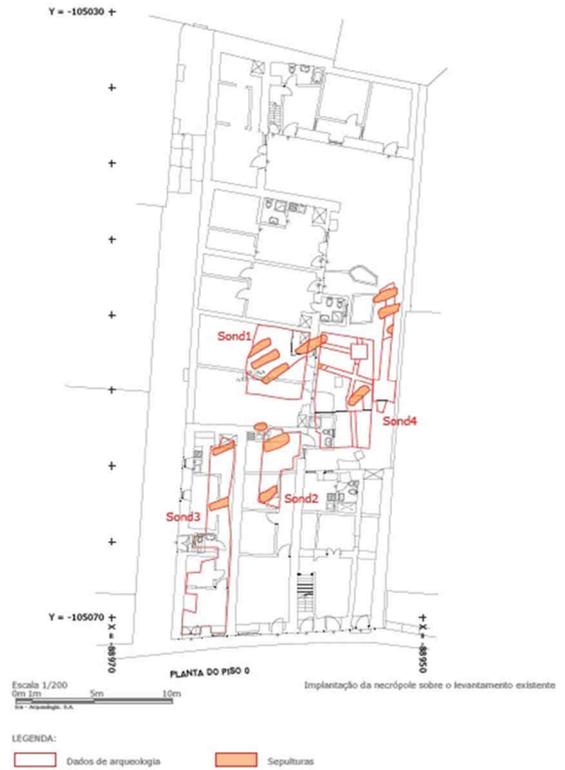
Localização das sondagens e sepulturas em planta de obra.
